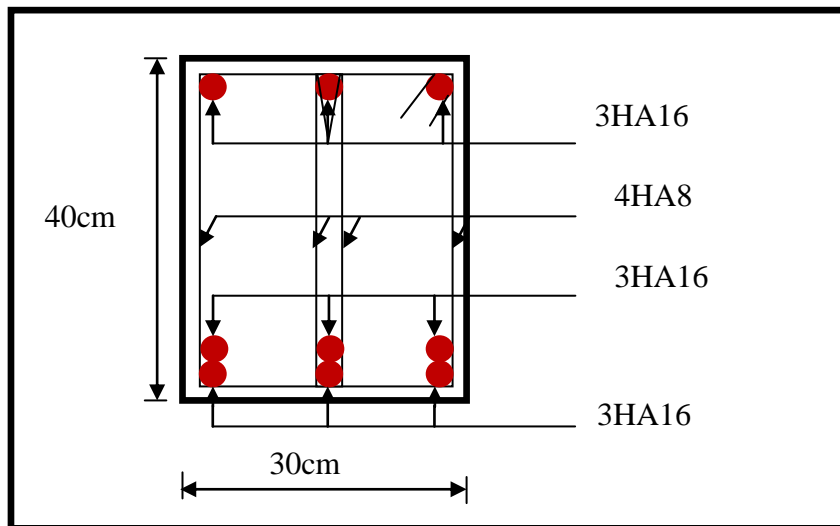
Ferrailage en travée d'une poutre principale.
